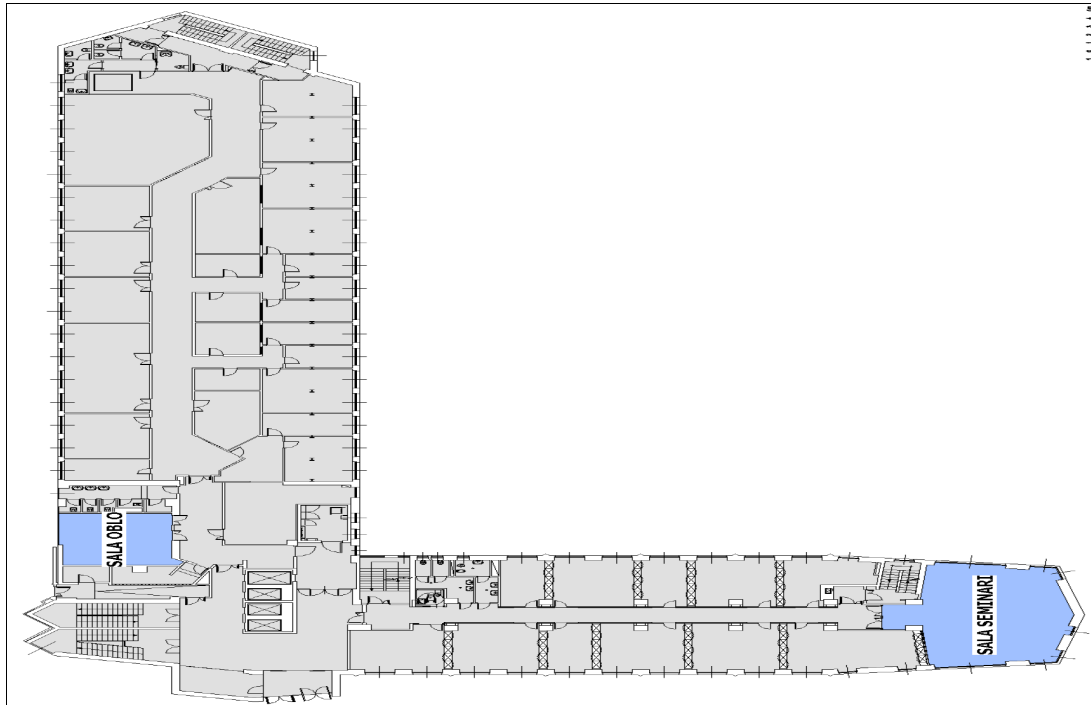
Planimetria del piano terra dell'Edificio 14 (Politecnico di Milano, 2012)
